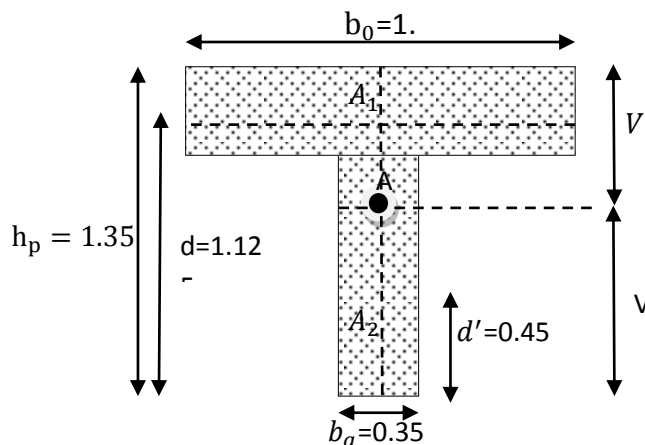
Notation pour la section de la poutre de rive avec hourdis
